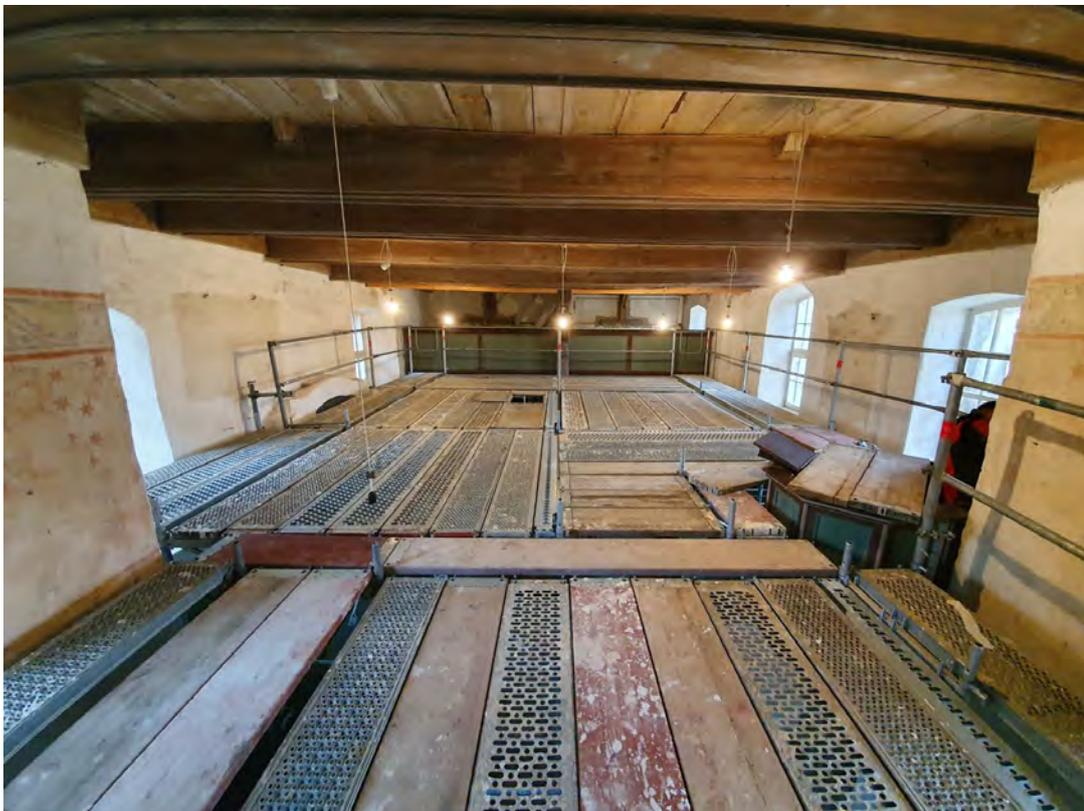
Kirche mit Baugerüst noch mit alter Decke
